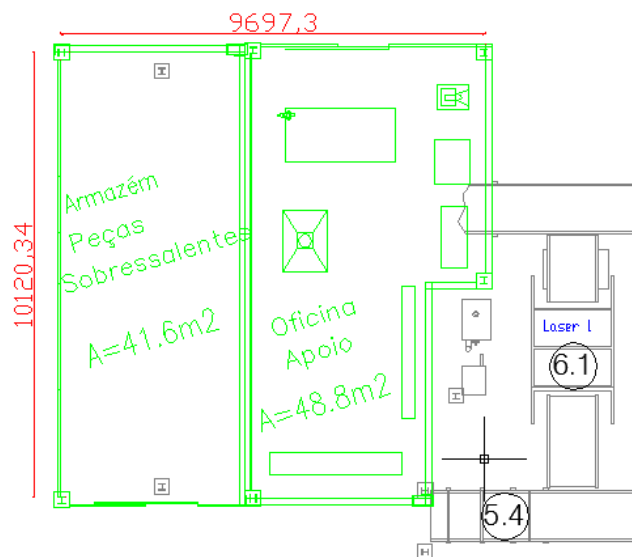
Layout* armazém de sobressalentes dos equipamentos e oficina de apoio
